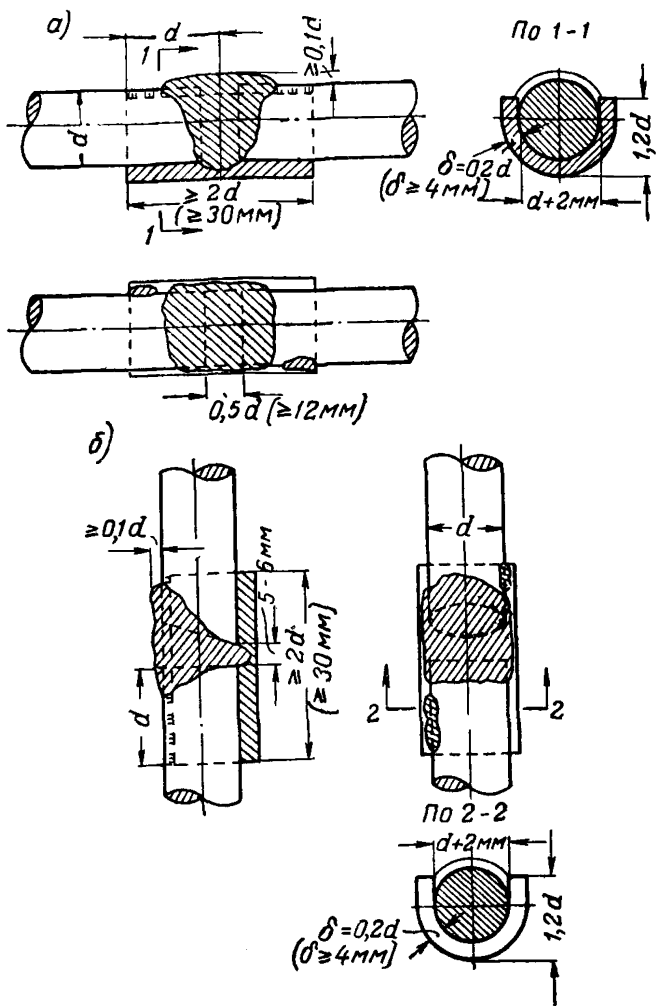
Стыки стержней электродуговой сваркой на подкладках с заваркой торцов
